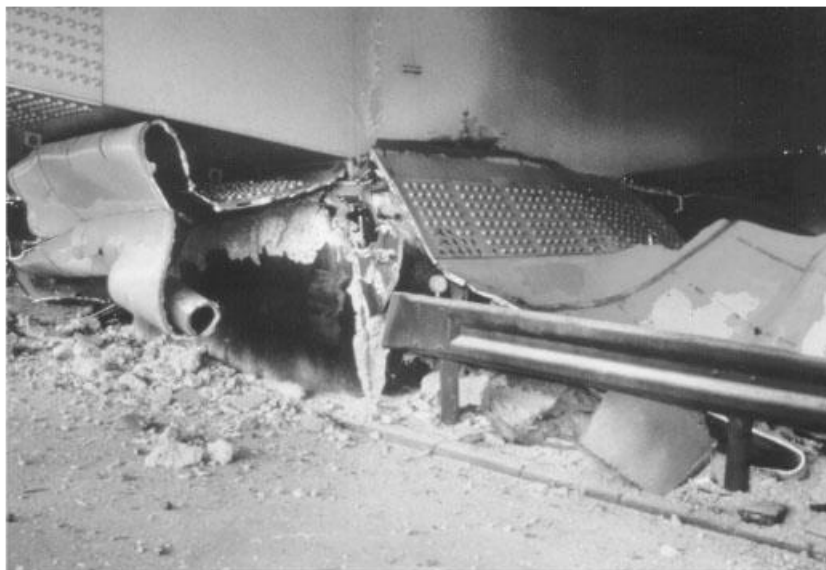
Vista mais pormenorizada do pilar colapsado.
